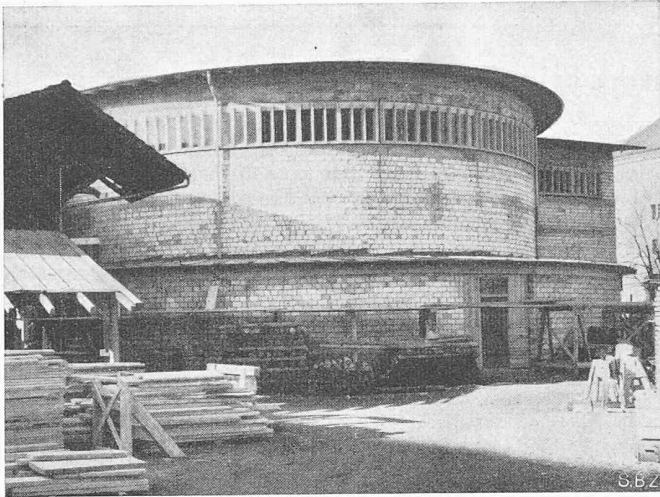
Aussenansicht mit Seiteneingang, rechts Sängerraum. Nach dem Abbruch des Notbaues links wird an dessen Stelle das Chor (2. Etappe) erstellt
